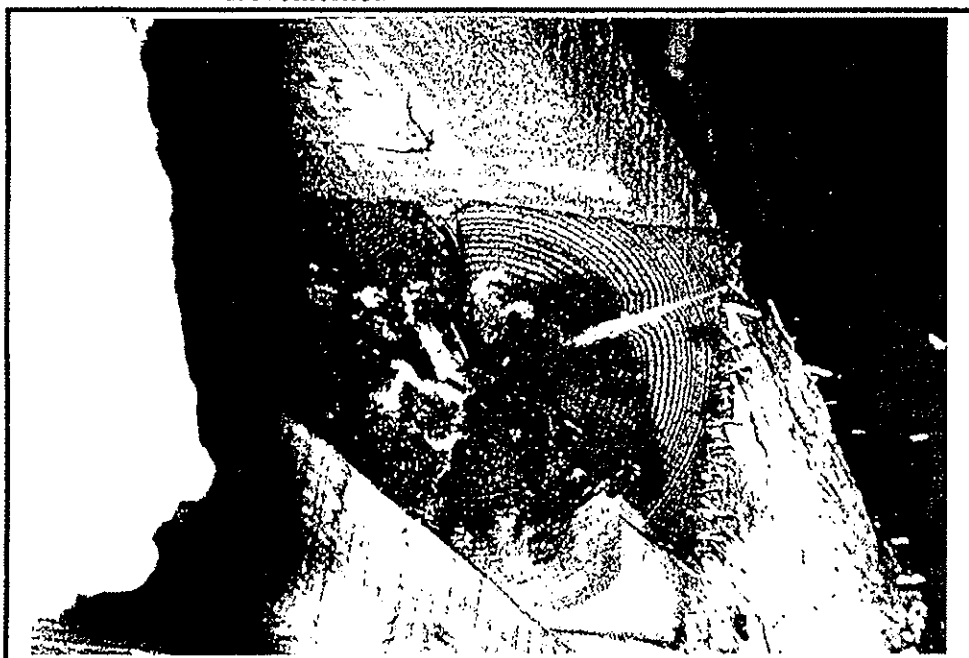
SZ krov, lokalita 5: Totální destrukce ponechané části krokve po opravě
